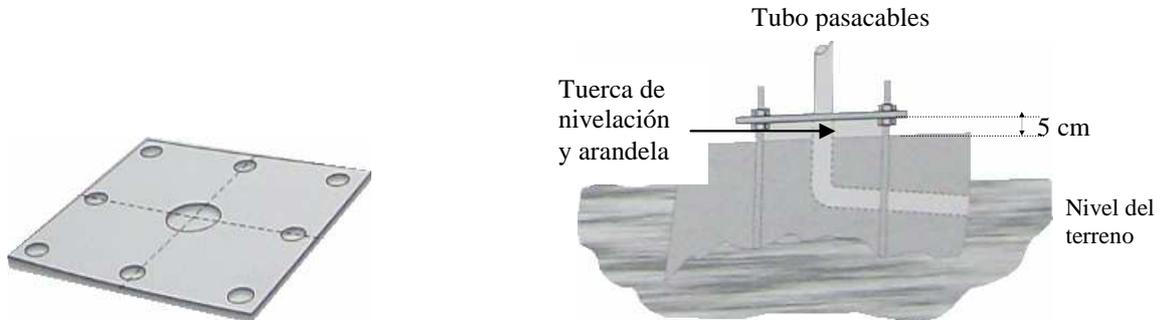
Plantilla para marcar los puntos de anclaje, y corte transversal de la zapata y de la plantilla una vez posicionada ésta.
